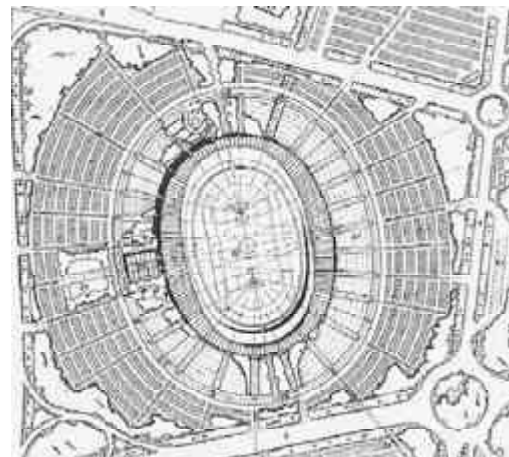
Planta de conjunto del estadio San Nicola.
